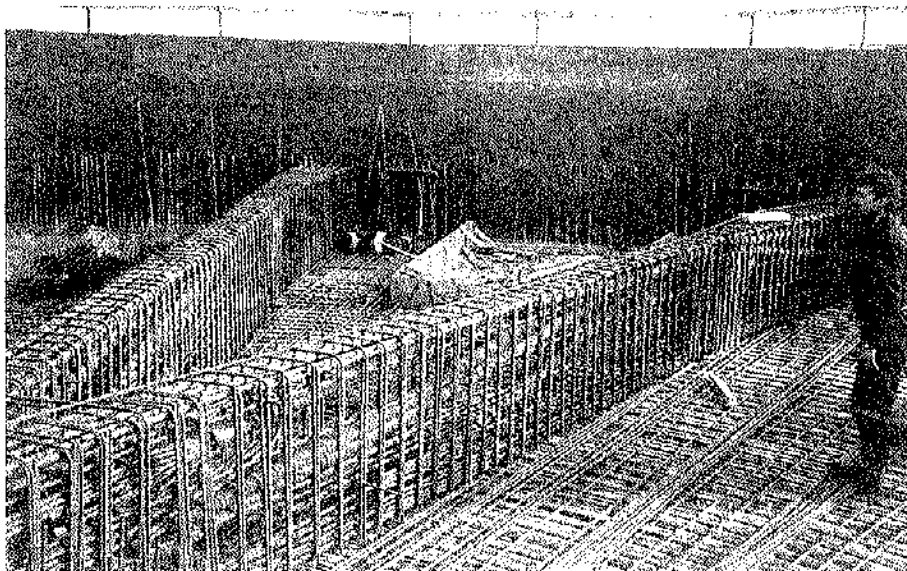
Detalle de armadura de las vigas postensadas de cubierta.
